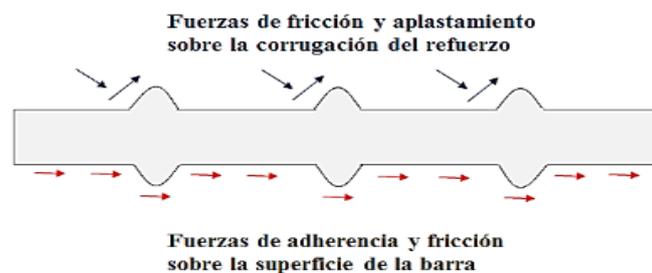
Fuerzas que actúan entre las barras de acero corrugado y el concreto.
